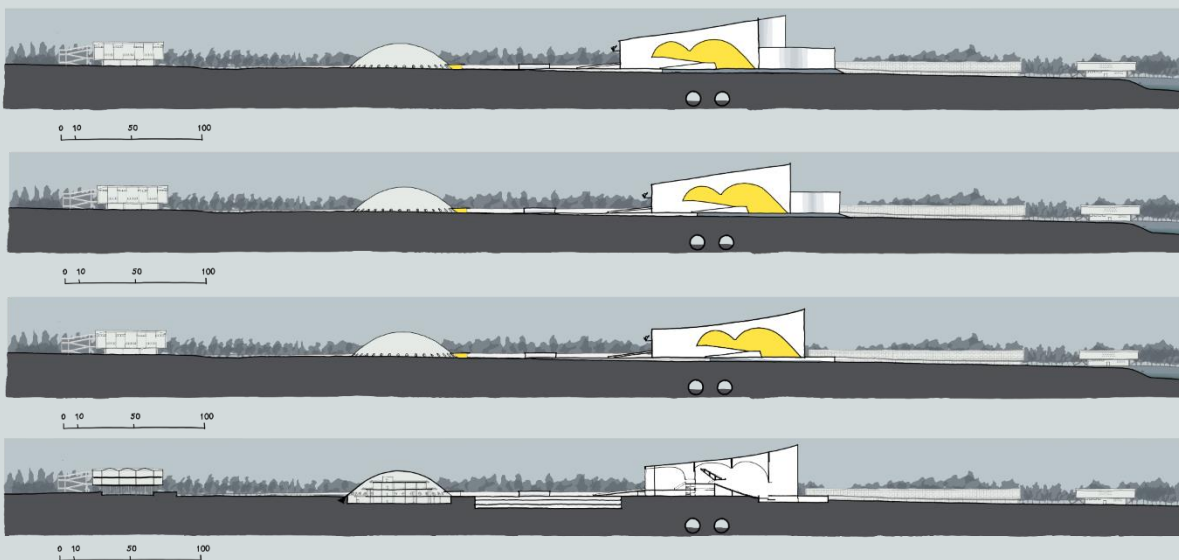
Implantação – 2002 – Versão 01 – desenho nosso.
